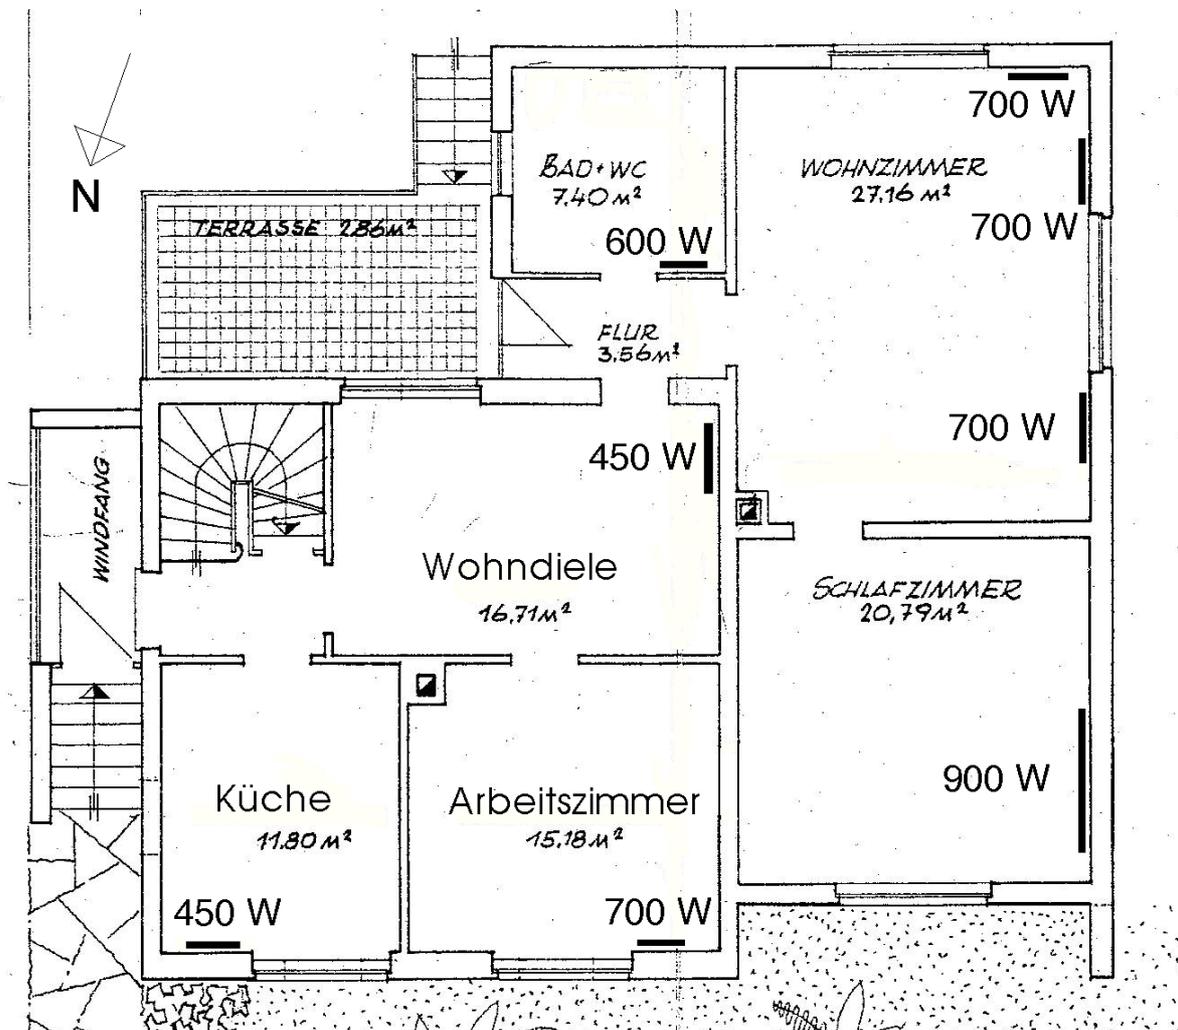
Grundriss Erdgeschoss des Maßobjekts
